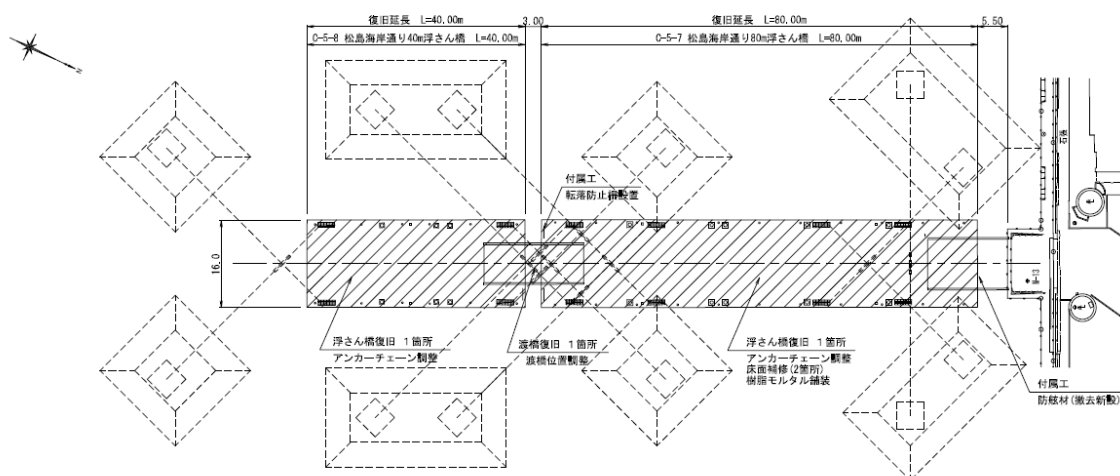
No.1 松島海岸通り浮棧橋の平面図（復旧後）
